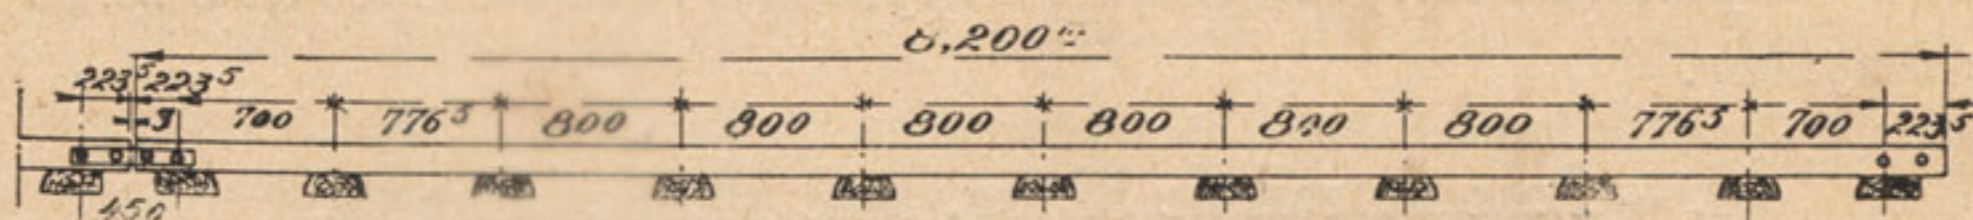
Rail de 8,20 m. profil 52 kg. posé sur 11 traverses (sans plaques).
